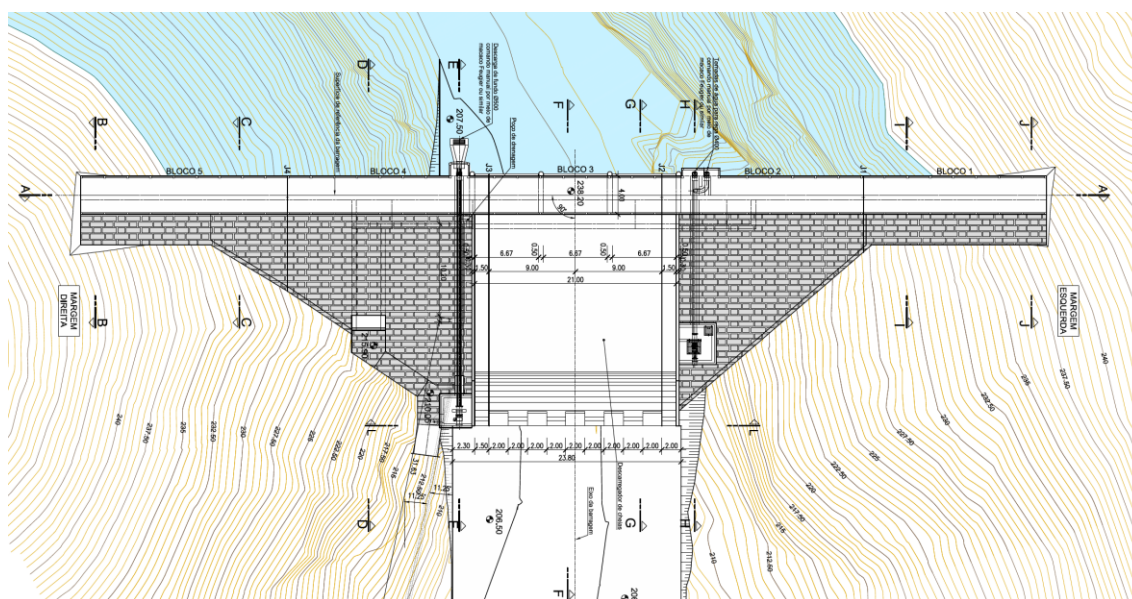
Planta da Barragem de Faveta (DGASP, 2011).
